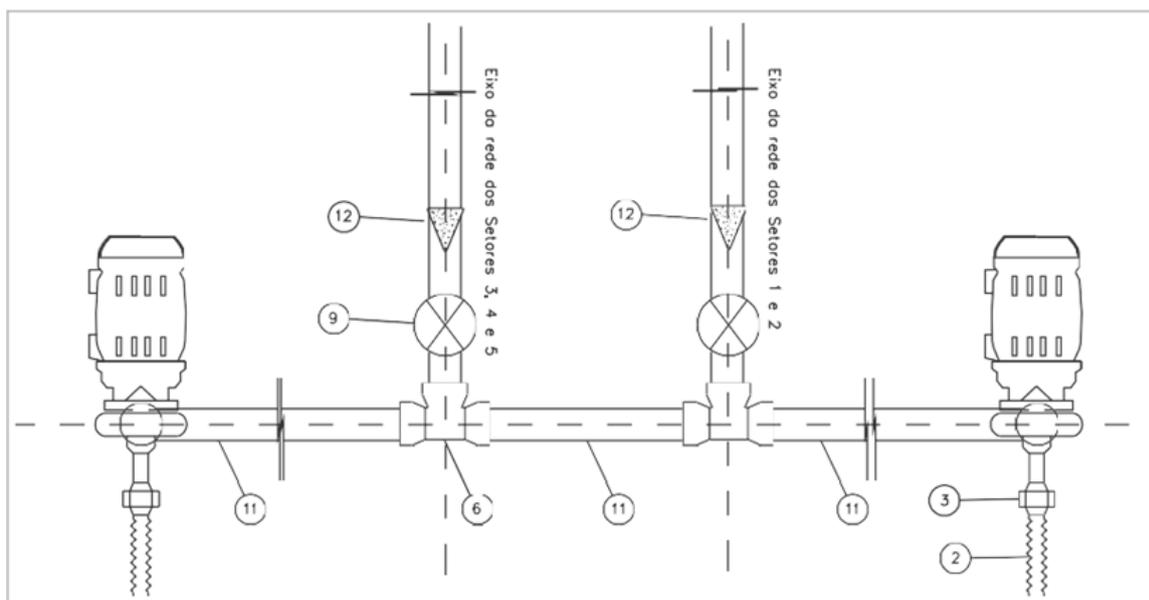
Detalhe da tubulação e conexões do barrilete.
